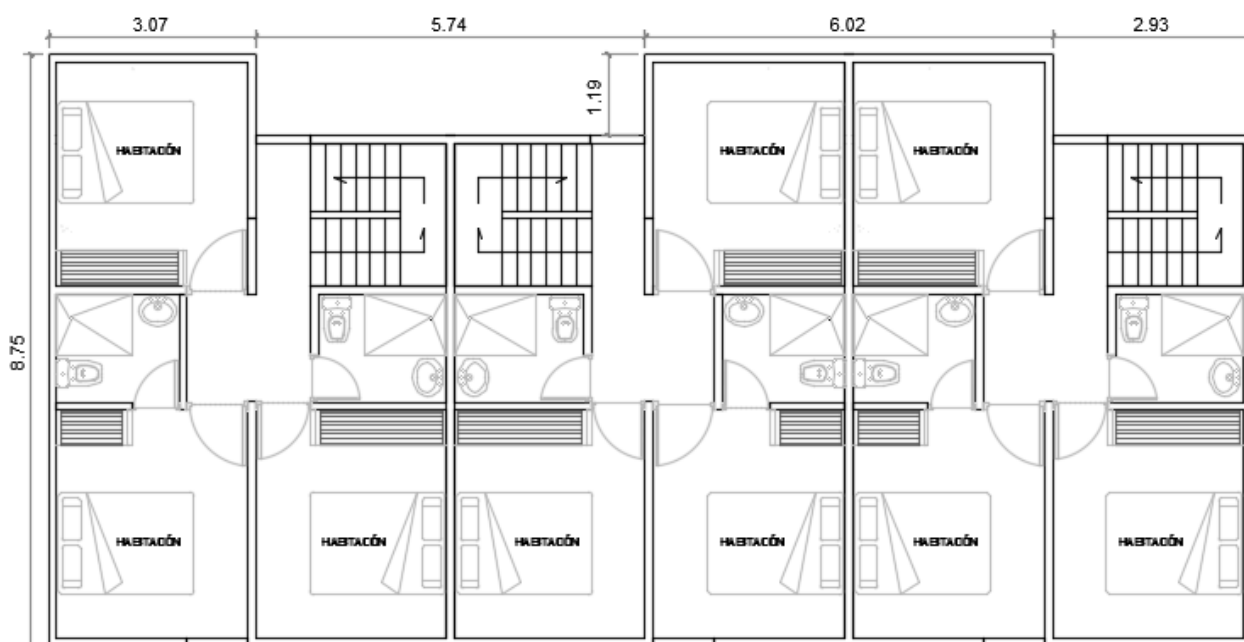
Diseño arquitectónico casa de dos pisos (200m<sup>2</sup>). Planta de segundo piso
